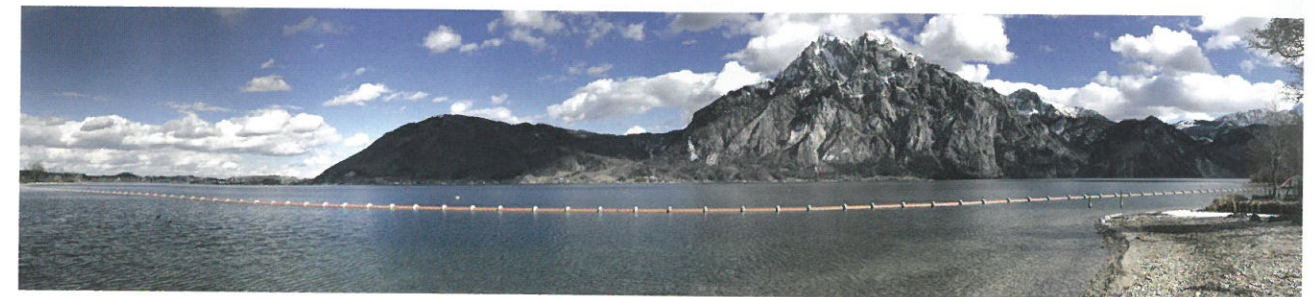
Wie eine Perlenkette schwimmt die mit Gewichten beschwerte AGRU-Abwasserdruckrohrleitung vor dem majestätischen Traunstein.
